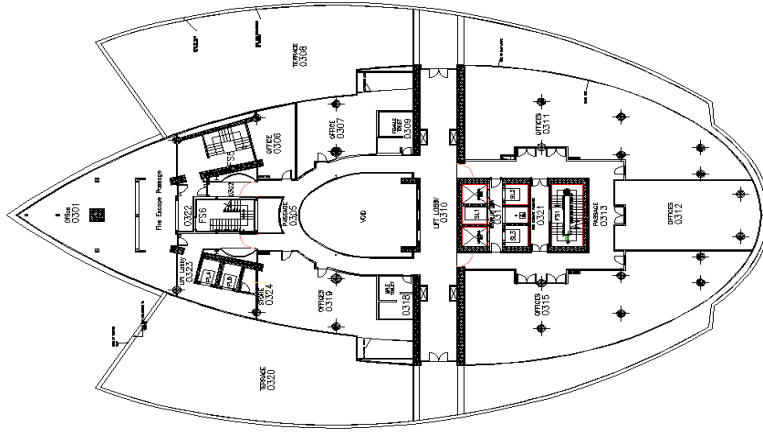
مسقط افقي للطابق الارضي
